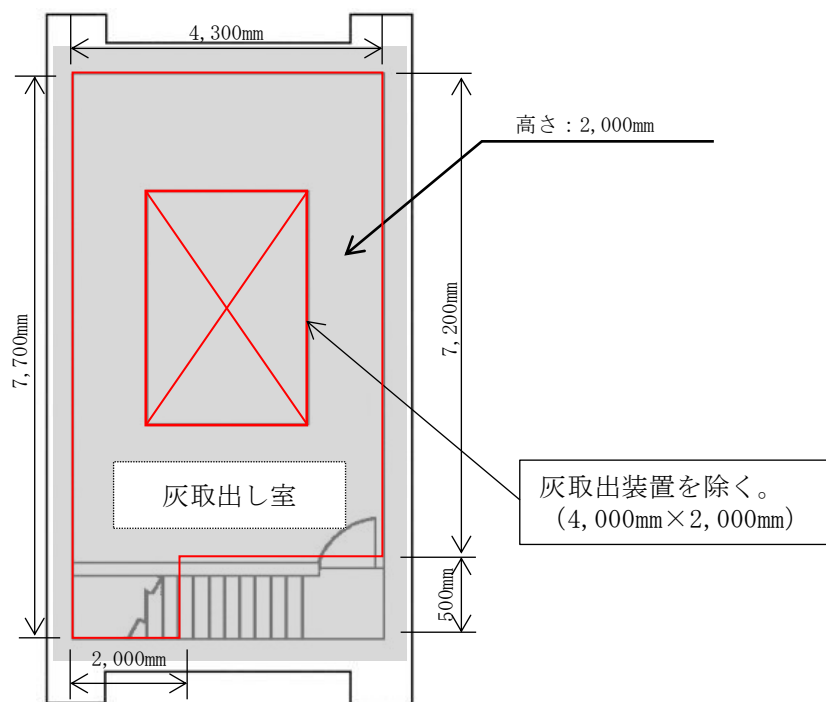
第1 廃棄物処理棟発生廃棄物保管場所（灰取出し室）平面図
